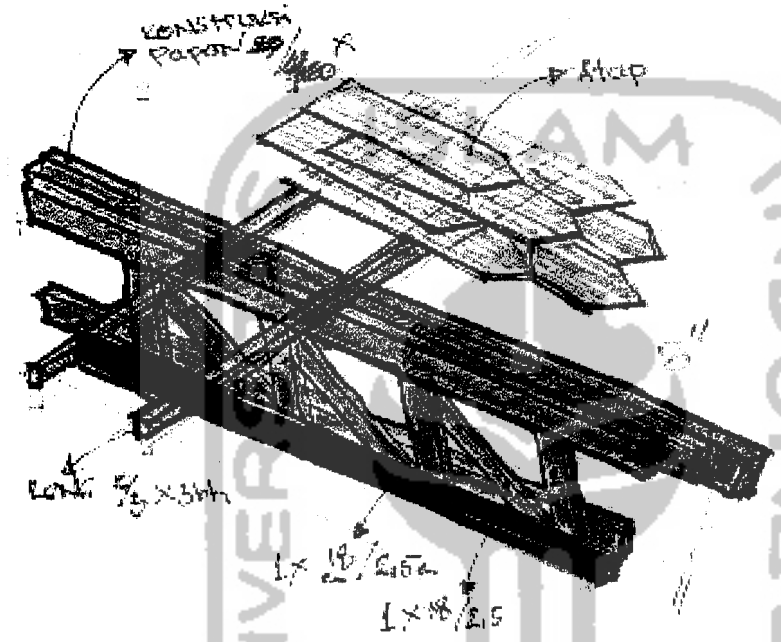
DETAIL SAMBUNGAN STRUKTURAL PONDASI
